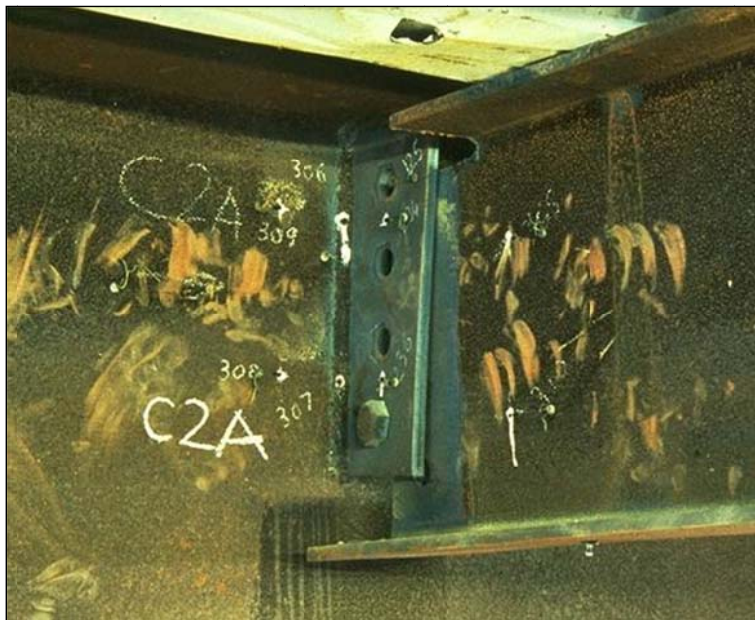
Assemblage par gousset soudé après le test
